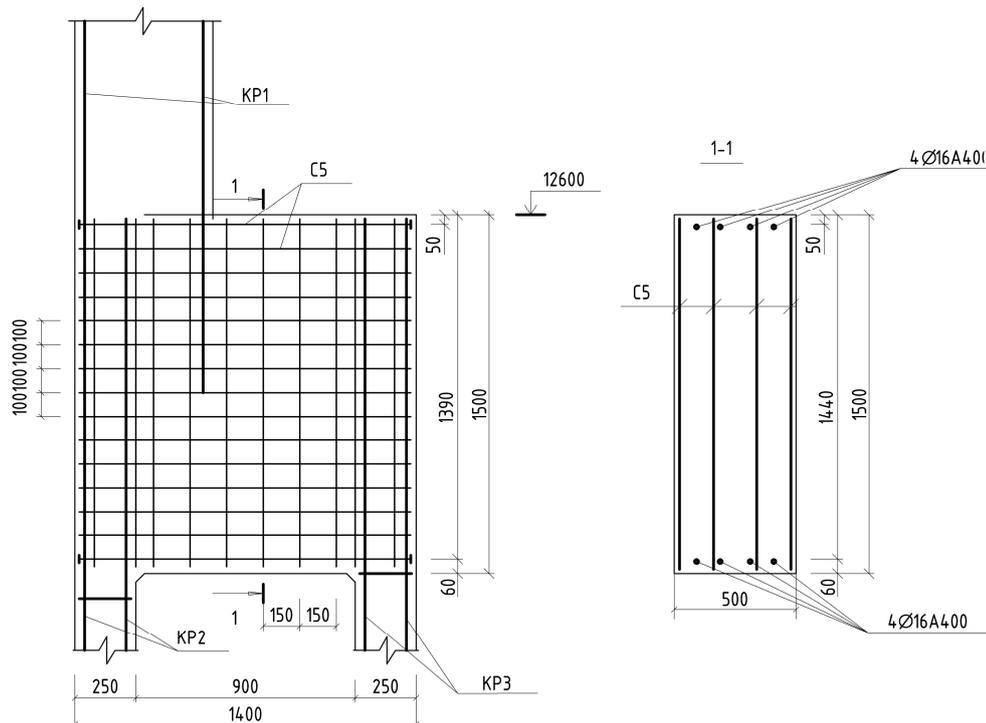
Конструирование подкрановой распорки крайней колонны
